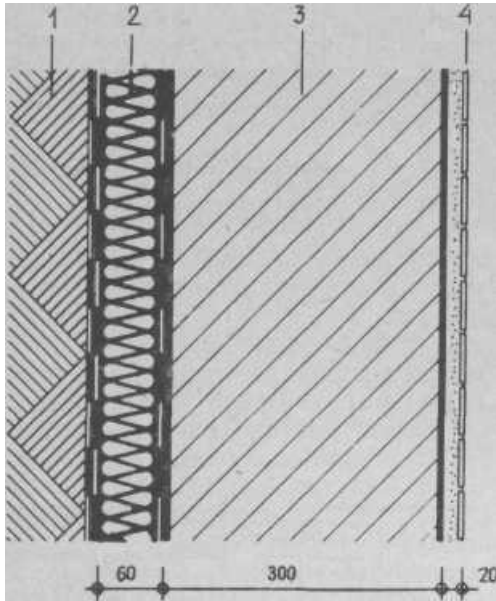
Обычная конструкция стены, примыкающей к грунту. Наружное расположение пароизоляции позволяет применять кладку с невысокими теплоизоляционными свойствами
